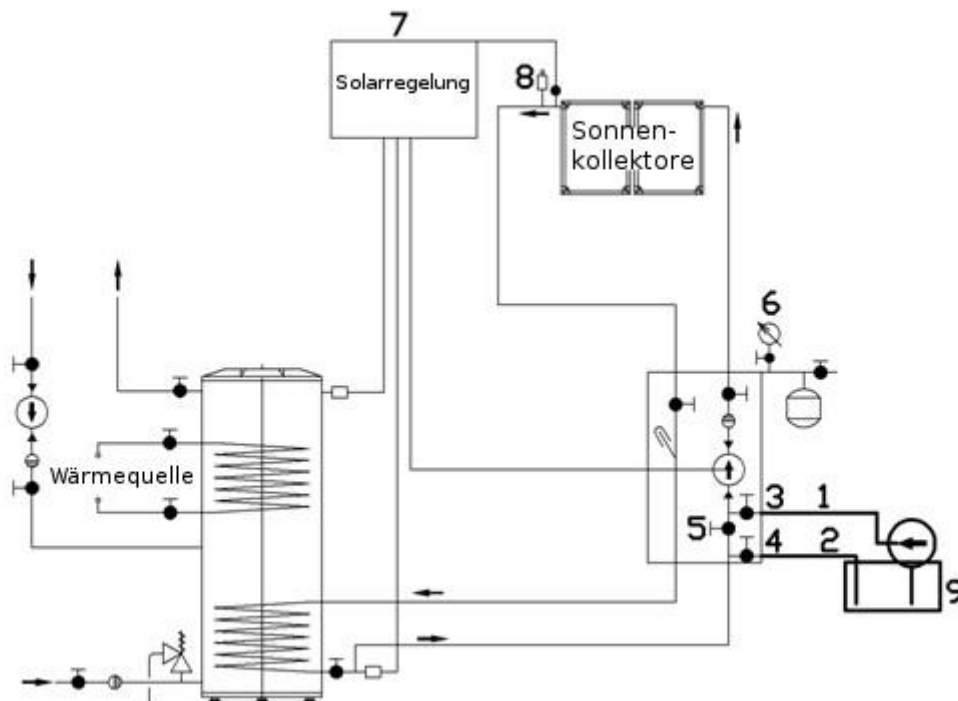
Befüllen der Solaranlage mit Wärmeträgermedium mit einer Befüllstation
